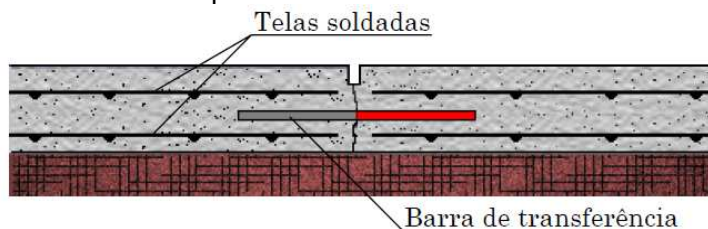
Perfil de um pavimento de concreto continuamente armado
